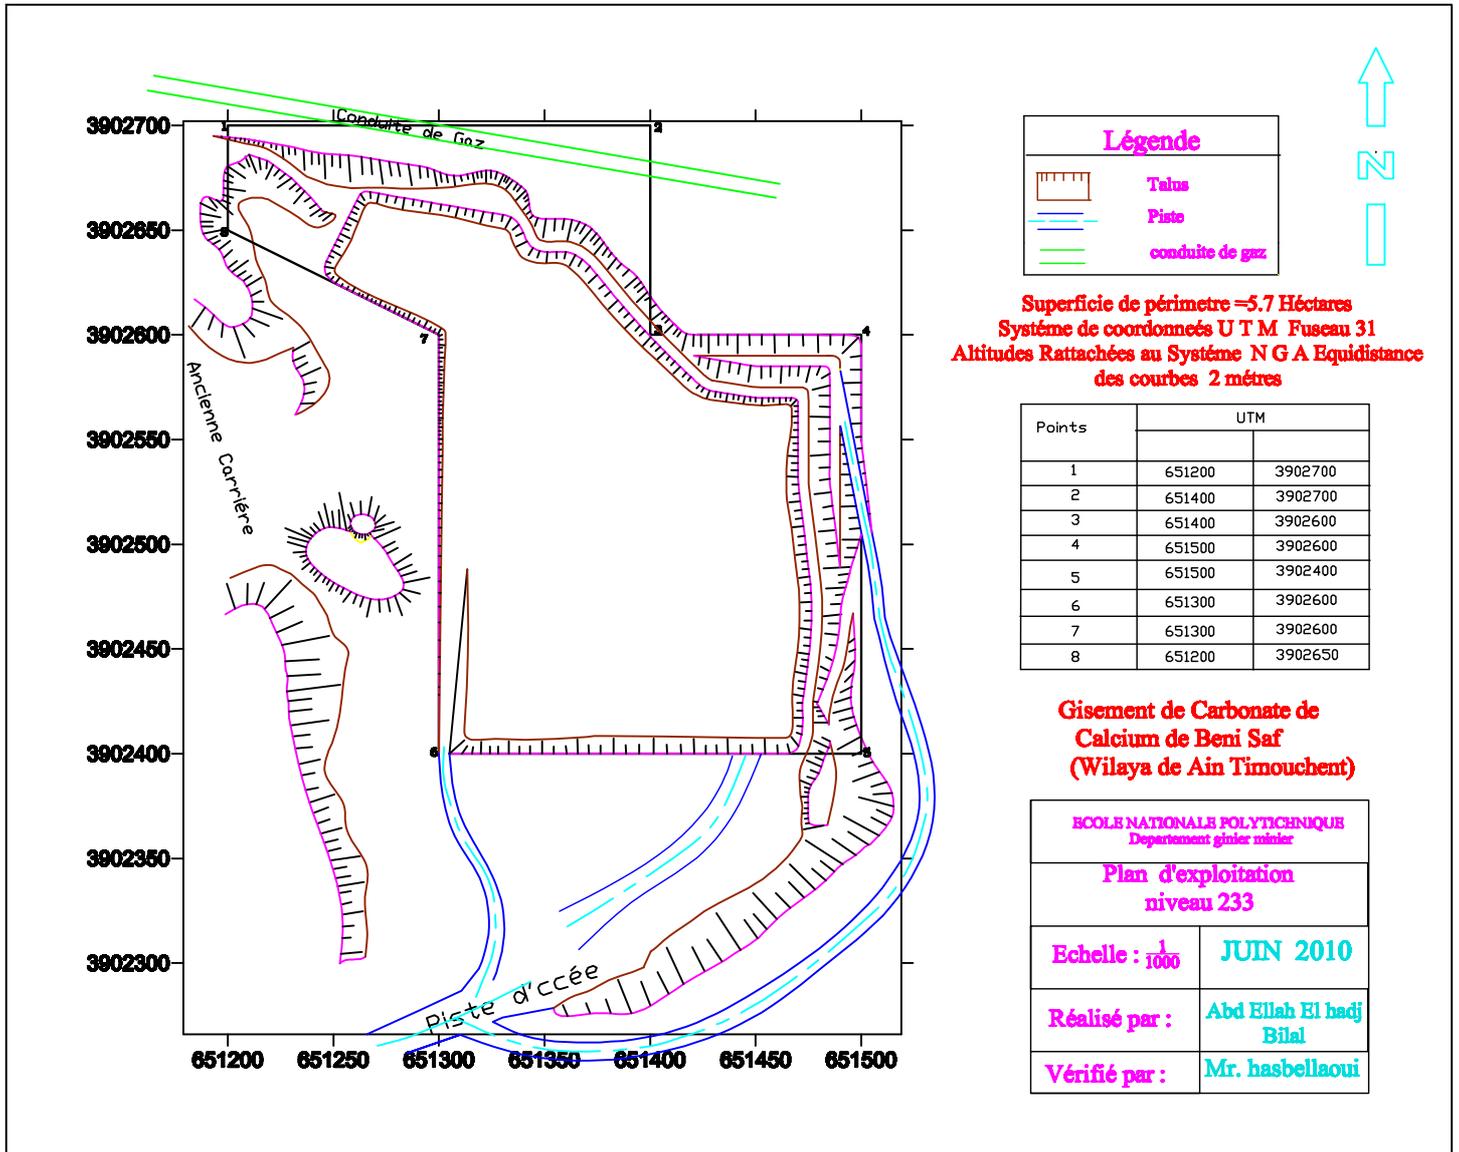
Plan Exploitation de la plate forme Niveau 233
